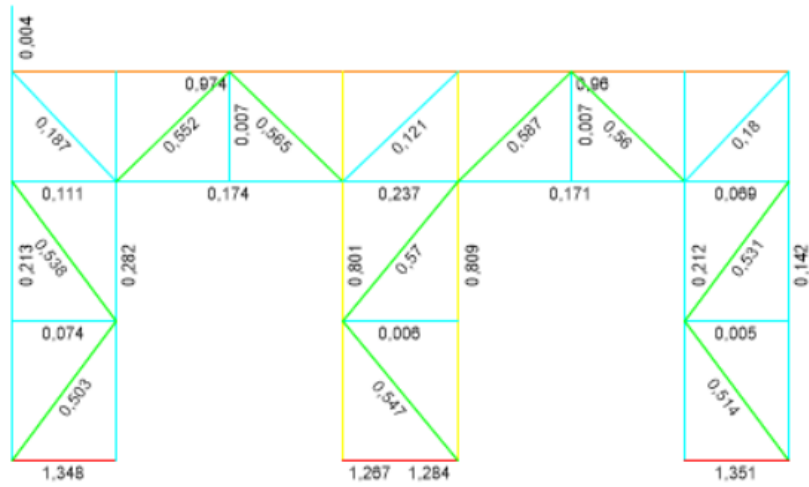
Factores de utilización vista en planta elevación 13.3 m.
